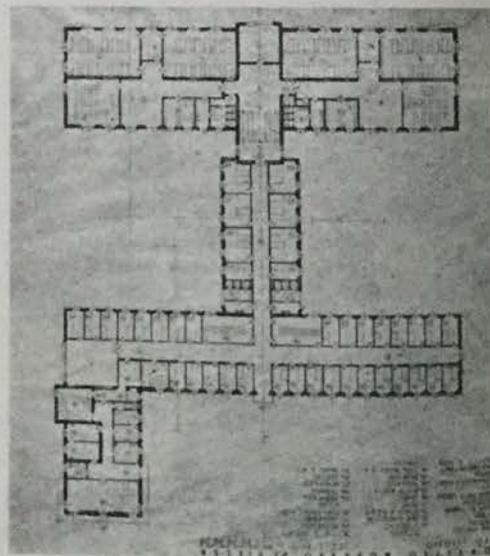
c - Convitto Biellese - I progetto: pianta del 2° piano.
